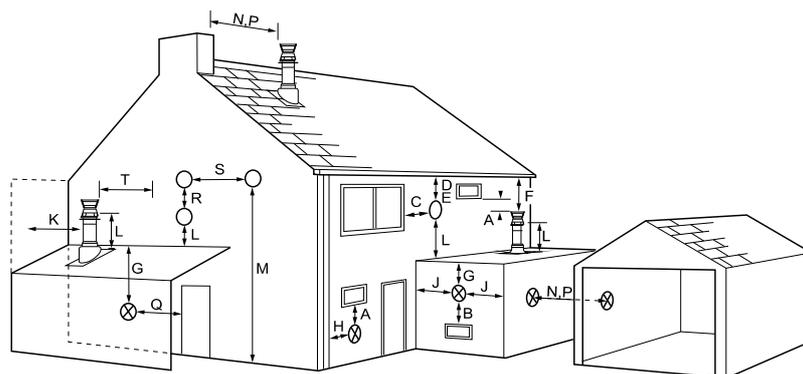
Определение положения трубопровода отвода дымовых газов снаружи здания относительно наружных конструктивных элементов здания
